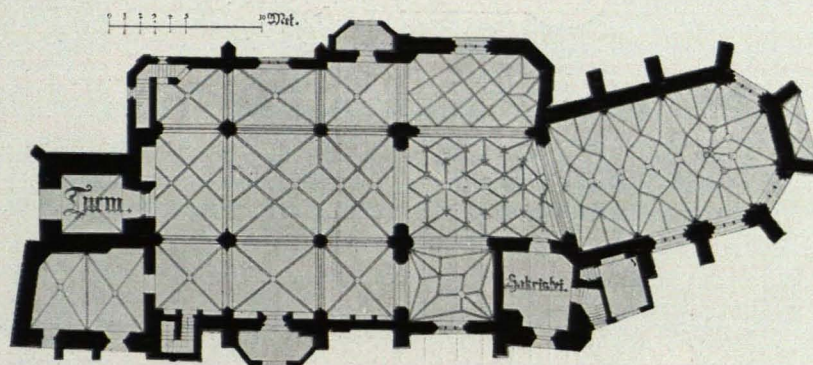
Spitz, Pfarrkirche, Grundriß 1:500 (S. 383)
